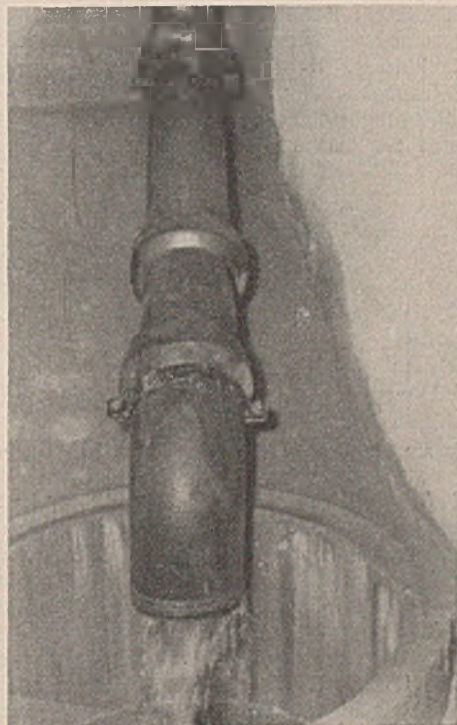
Bauwerk I, Einmündung des Fallrohres in den Betonschacht.
